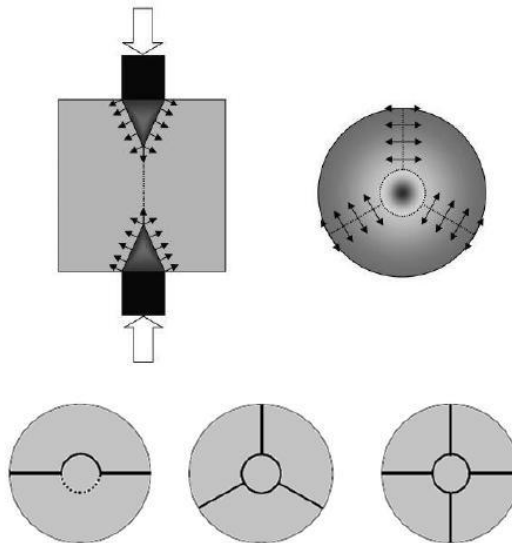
Cuñas de compresión y tracción; Planos de fisuración tipo de ensayo de doble punzonamiento. (Carmona, 2009).
